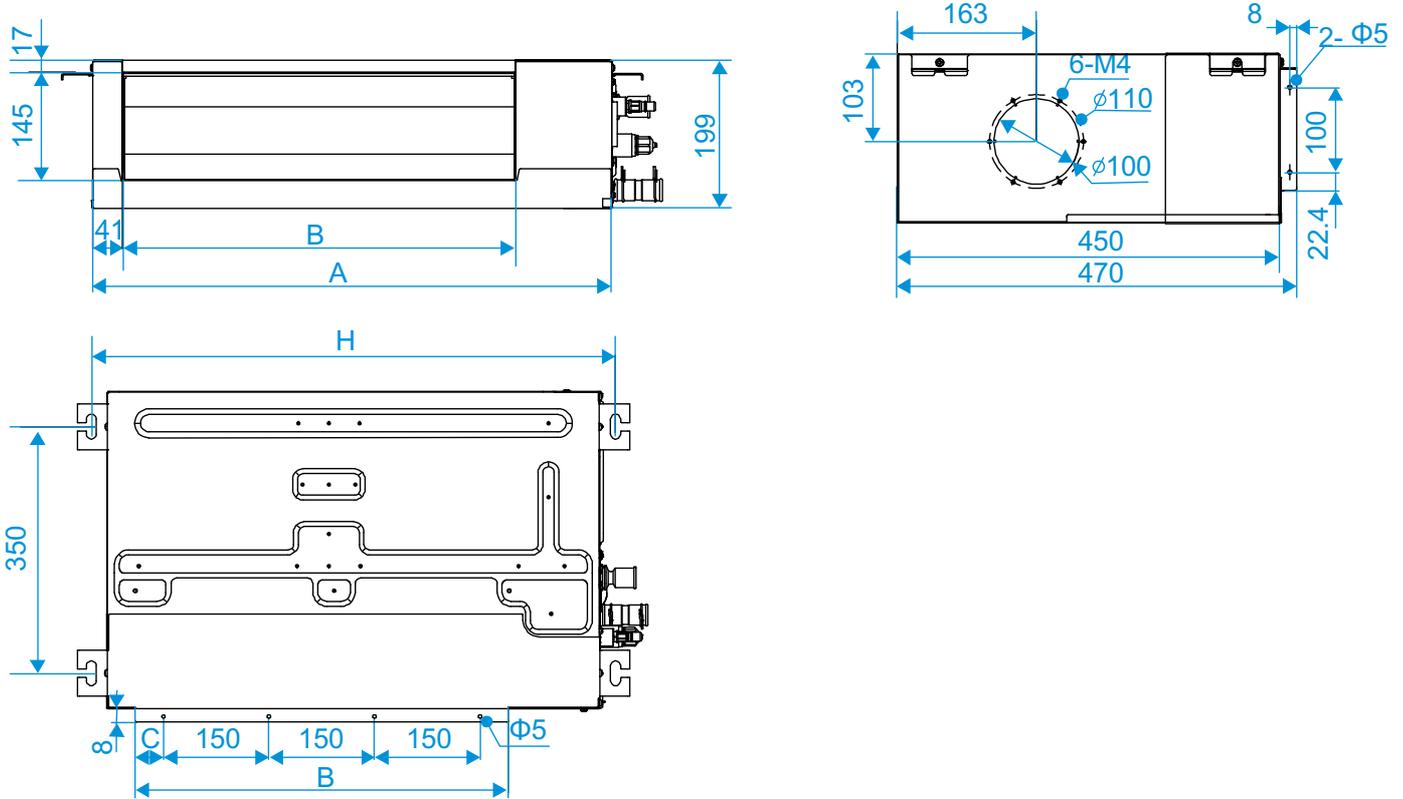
Taille de l'entrée d'air de retour (mode de retour d'air arrière) : (unité : mm)
